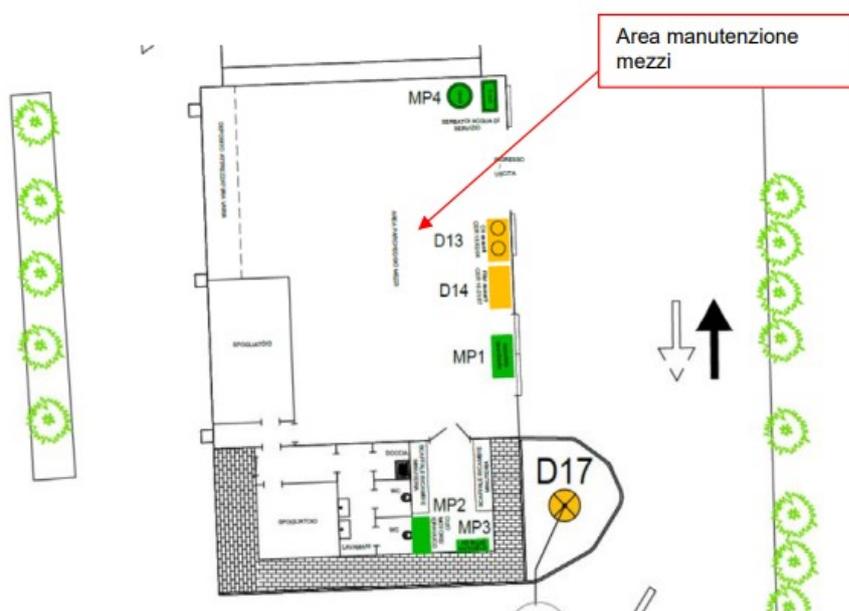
Stralcio planimetria deposito materie prime - Area manutenzione mezzi
